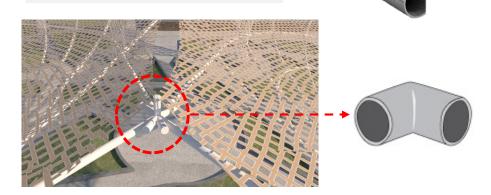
Estructuras plaza cultural Fuente: Elaboración propia.
